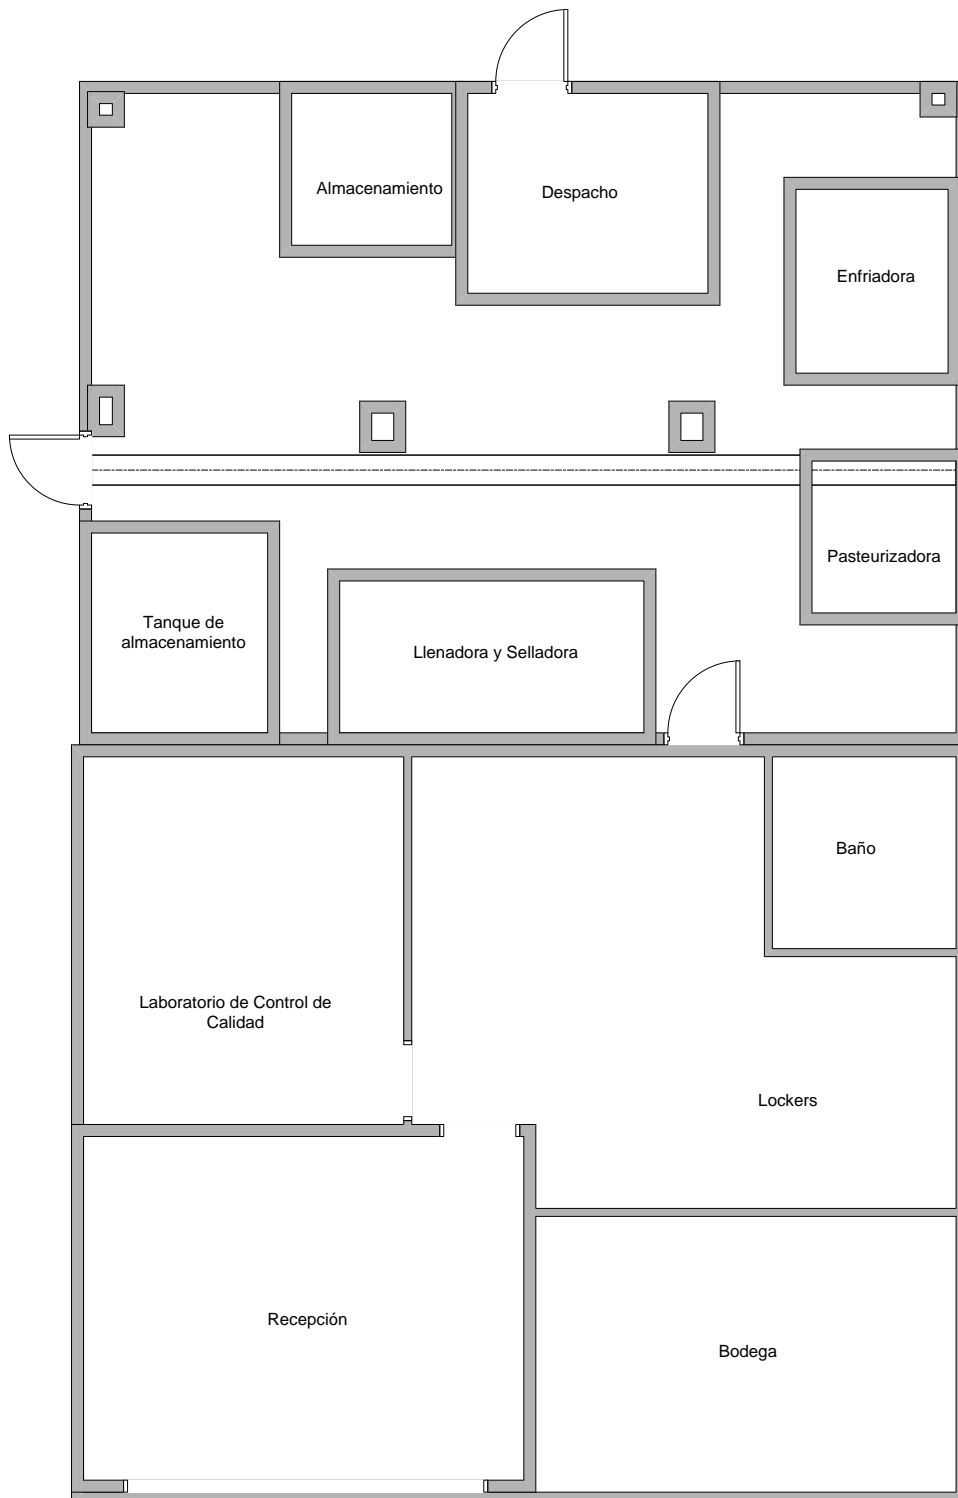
Plano propuesto de la planta de pasteurización de CEDECO.
